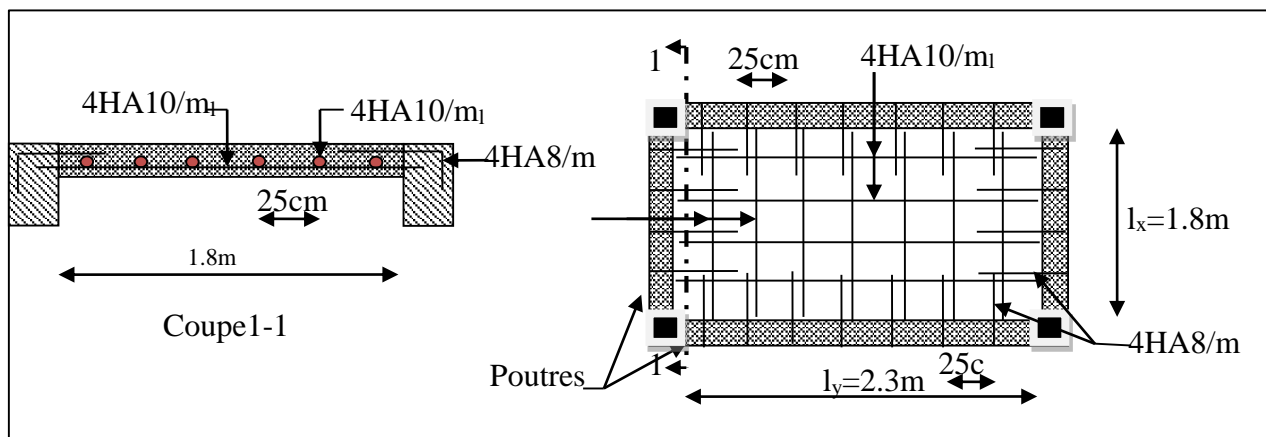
Schéma de ferrailage dalle pleine du locale machinerie.
